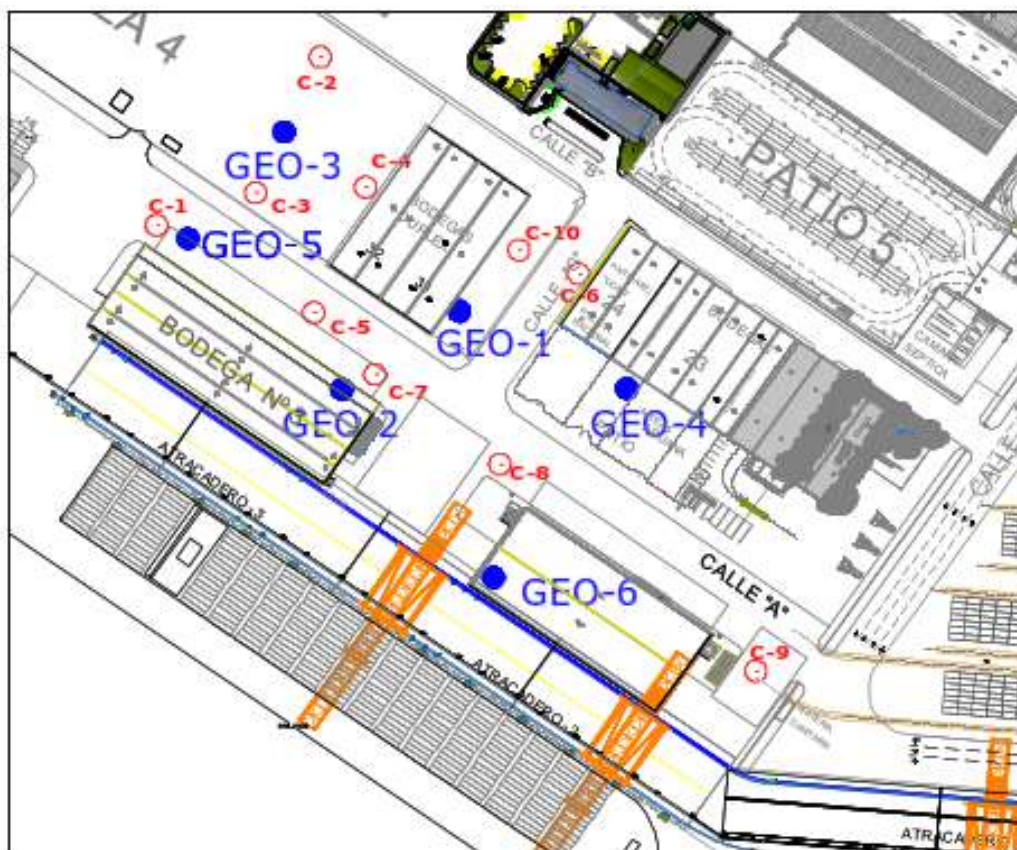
Vista en planta de la campaña de exploración del proyecto
